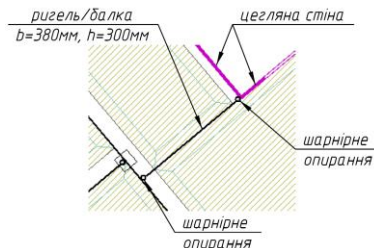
Фрагмент влаштування ригеля/балки на цегляну стіну (збірна залізобетонна перетинка)
